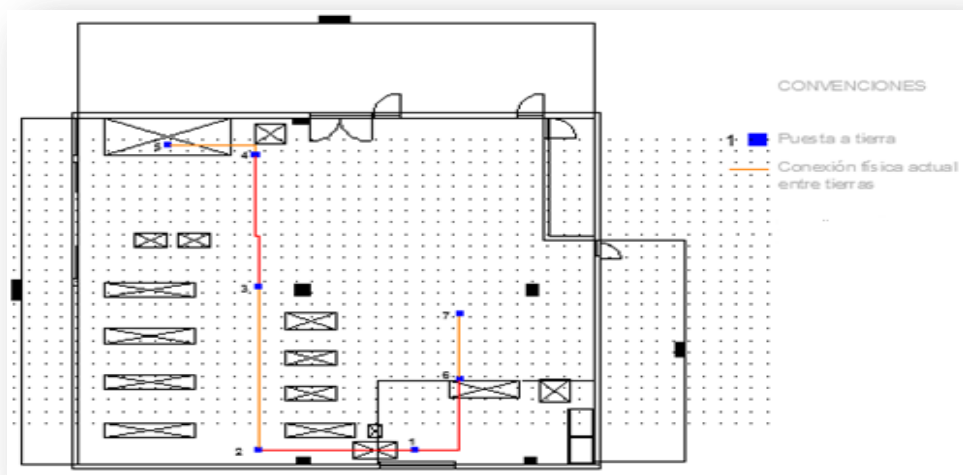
Vista de planta del laboratorio del banco para pruebas actual
